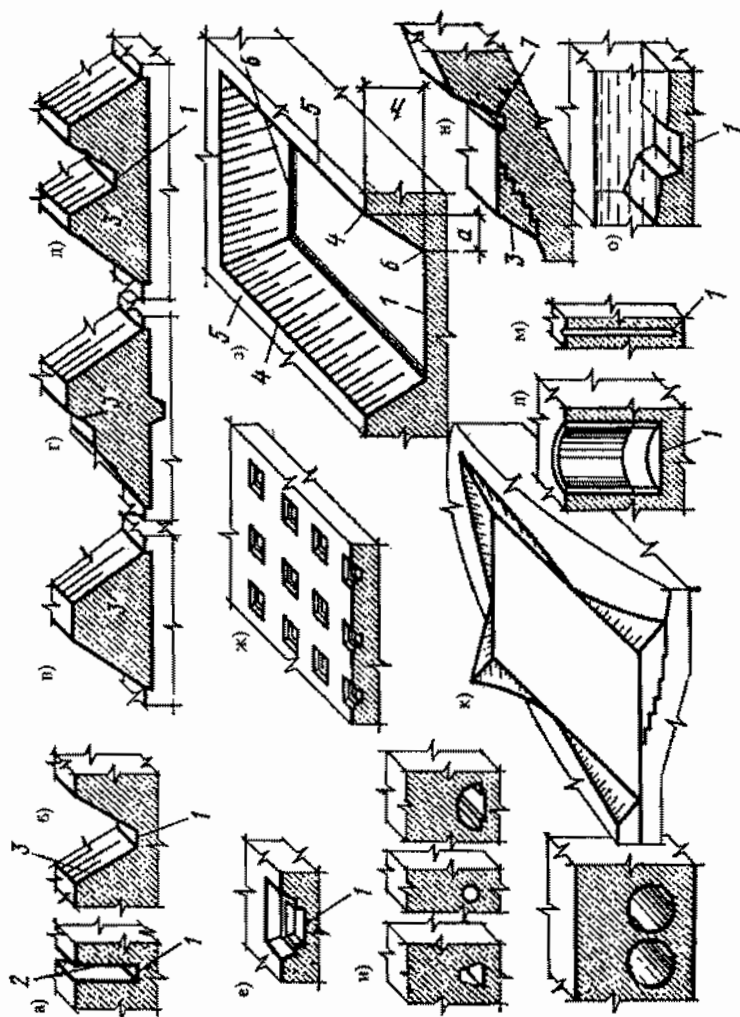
Виды лемных сооружений: а, б - траншеи с вертикальными стенками и с откосами; в - дамбы; г - плотины; д - канал в насыпи; е - котлован под фундаментом; ж - система котлованов под фундаментами колонн сооружения; з - котлован под сооружением; и - подземные выработки (для штольни, трубы, канализационного коллектора, тоннеля); к - площадка; л - выемка для опускного колодца; м - буровая скважина; н - полувыемка-полунасыпь; о - подводная траншея; 1 - дно (траншеи, канала, котлована, опускного колодца); 2 - боковая стенка траншеи; 3 - боковой откос (канала, дорожной выемки, котлована, насыпи, плотины, дамбы); 4 - бровка; 5 - берма; 6 - подолка; 7 - водоотводная кювет
